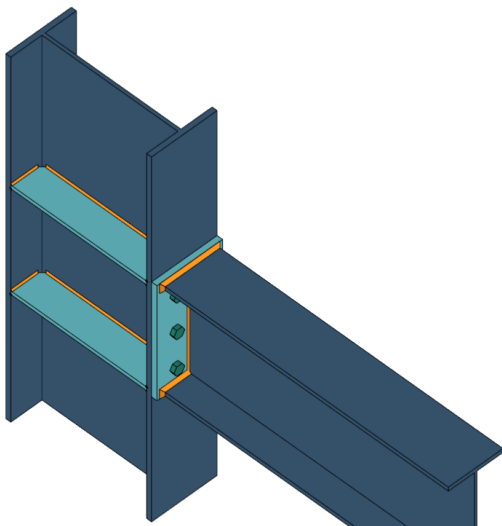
Encastrement poteau-poutre intermédiaire
